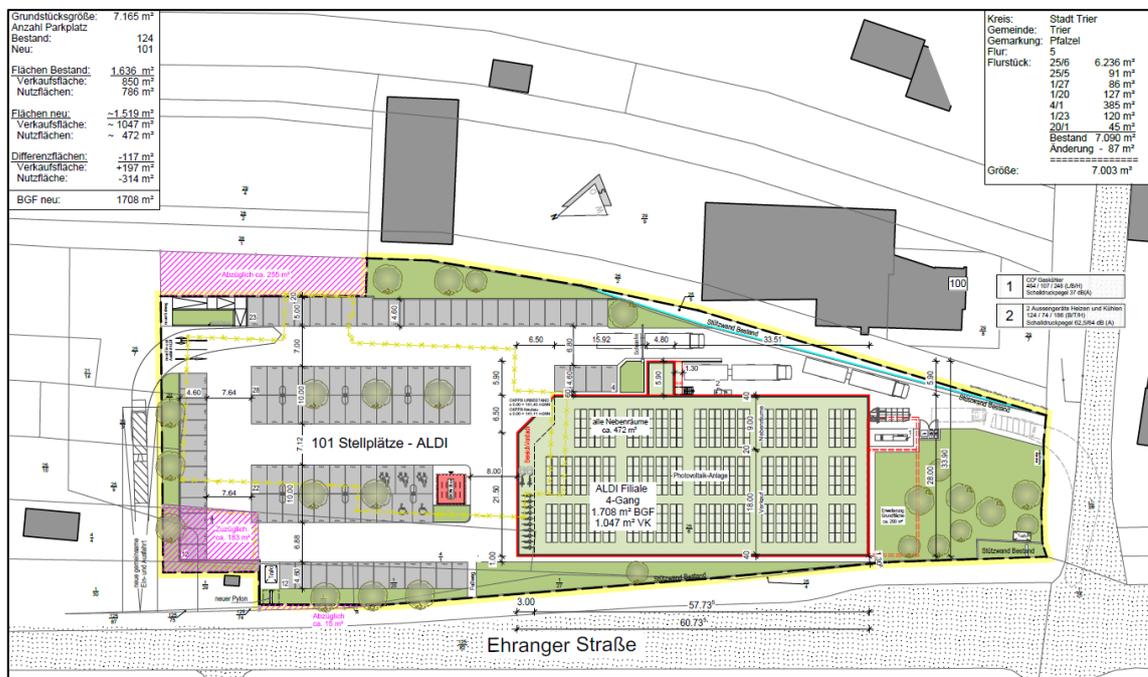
Vorhabenplanung mit Flächenbedarf gem. Darstellung von Kühn Architekten (23.01.2024). Rosa Flächen sind nicht Teil des Plangebiets und werden dem Bebauungsplan BE 34-1 zugerechnet.
